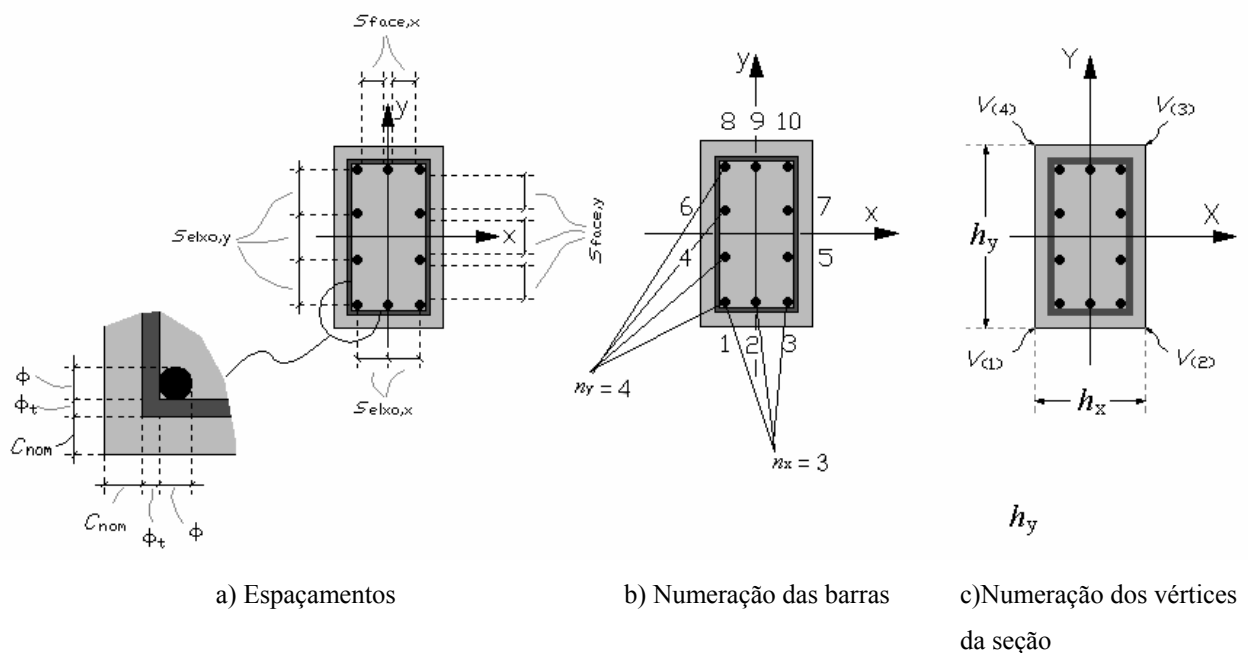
Seção transversal e arranjo da armadura da seção retangular.
